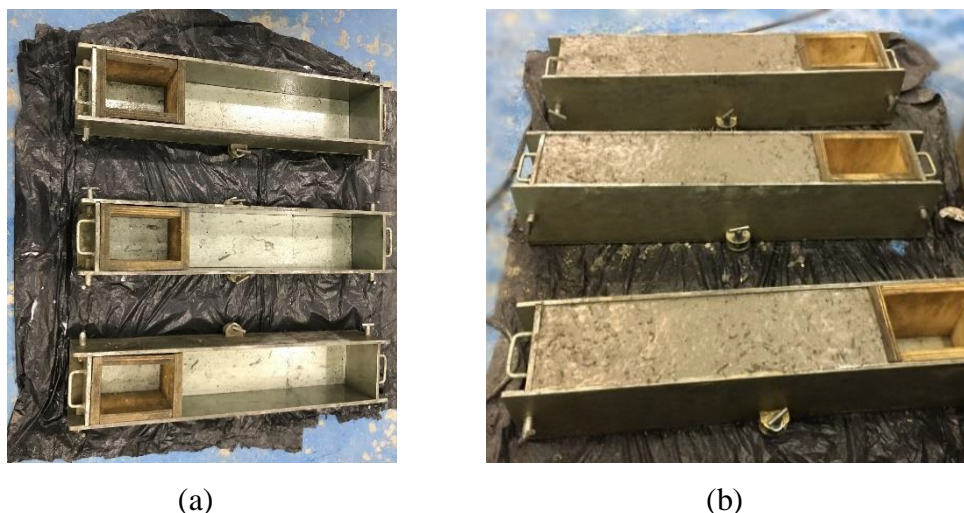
Formas metálicas utilizadas para moldagem dos corpos de prova prismáticos (a) e corpos de prova após finalização do procedimento de moldagem (b).
